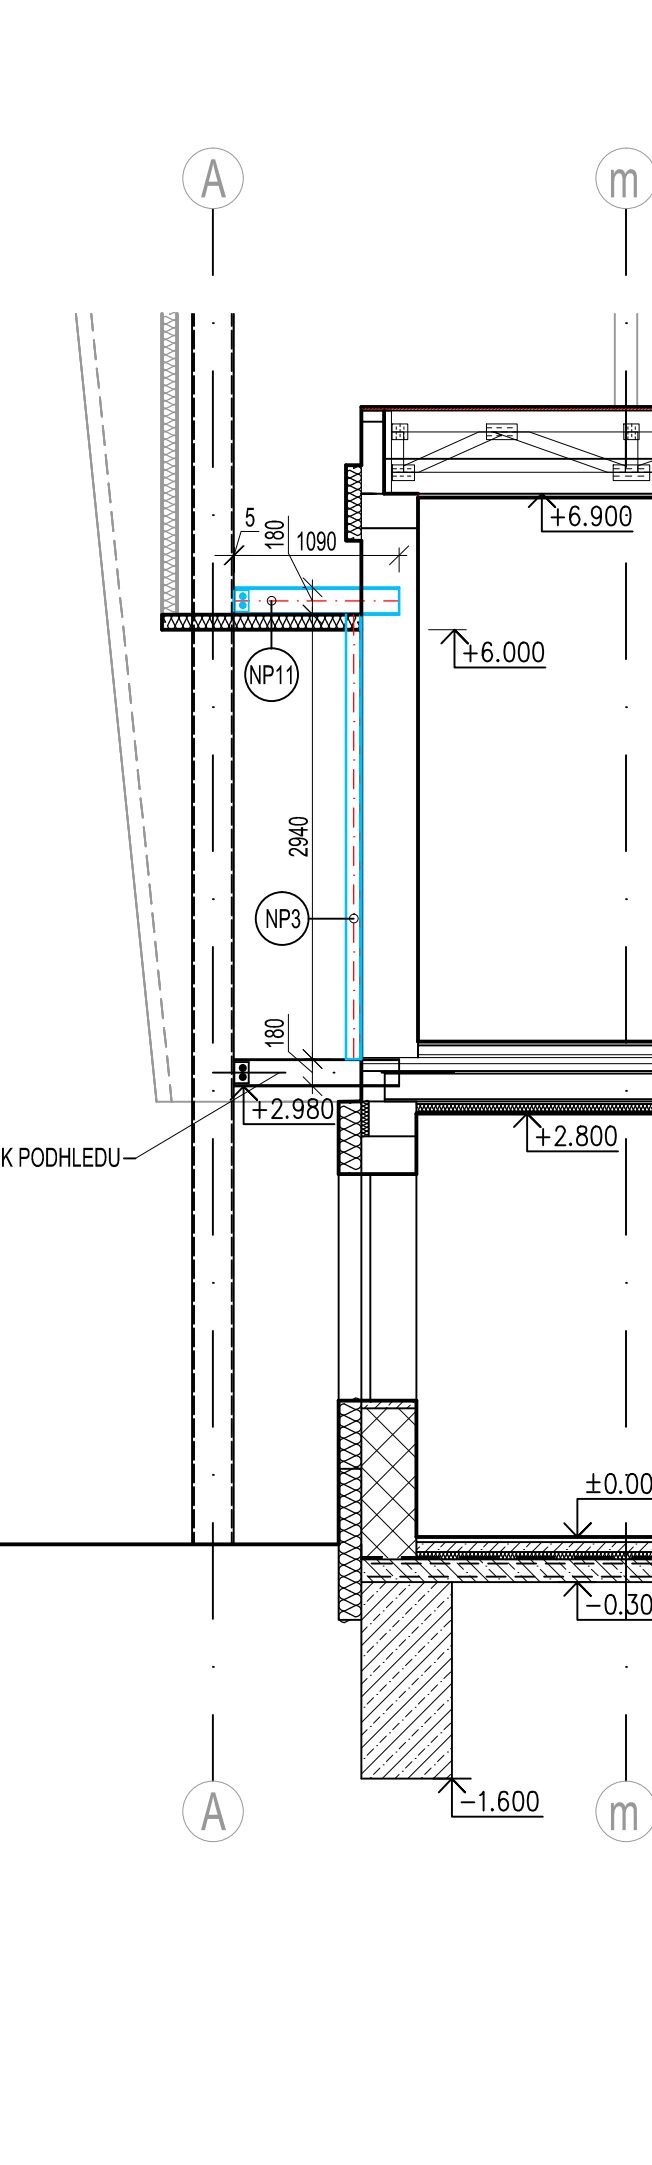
TYPICKÝ POHLED, M1:25
